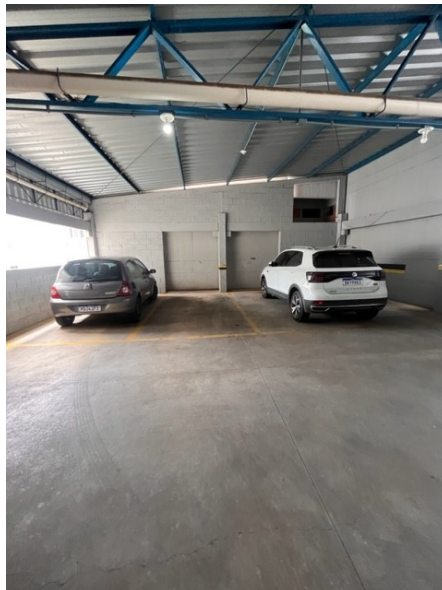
imagem da vaga nº52 apontado pelos condôminos.
